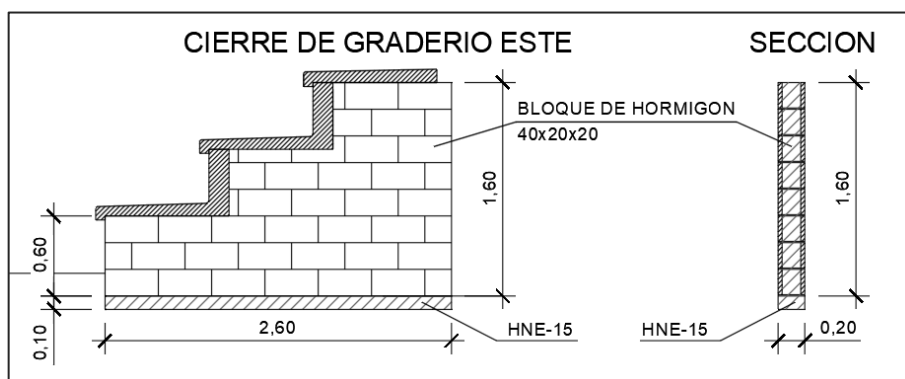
Muro transversal de bloques de hormigón macizados en el graderío este.
